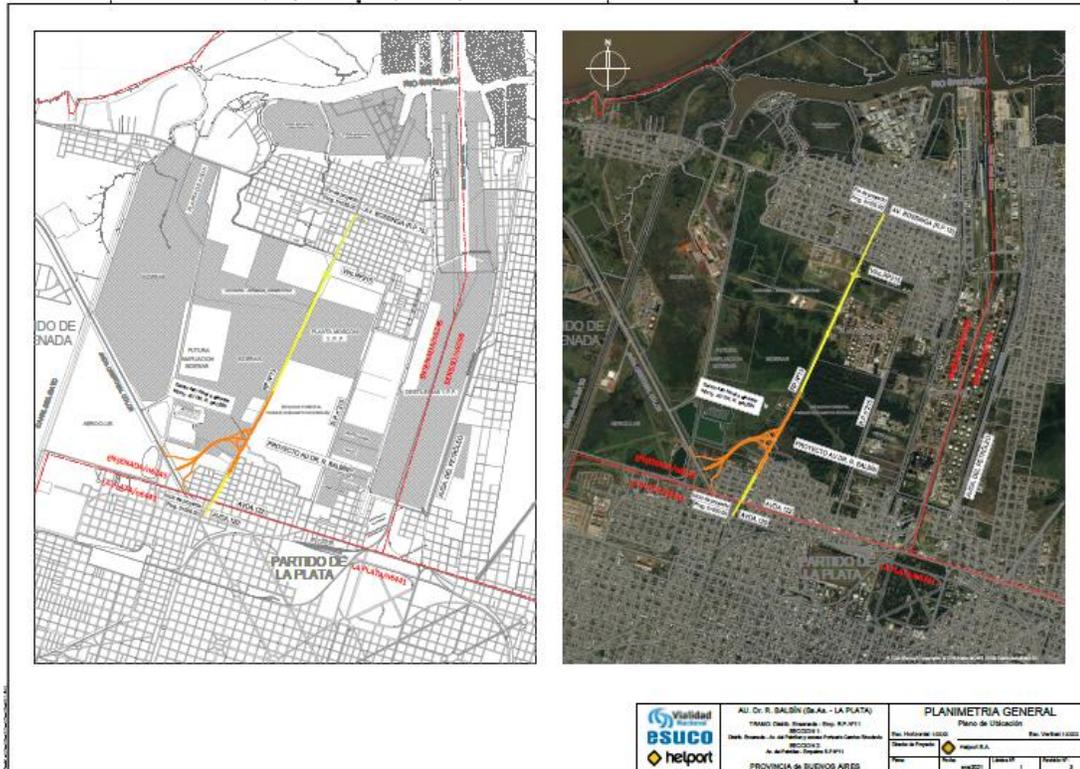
Planimetría General – Plano de Ubicación de las Obras
